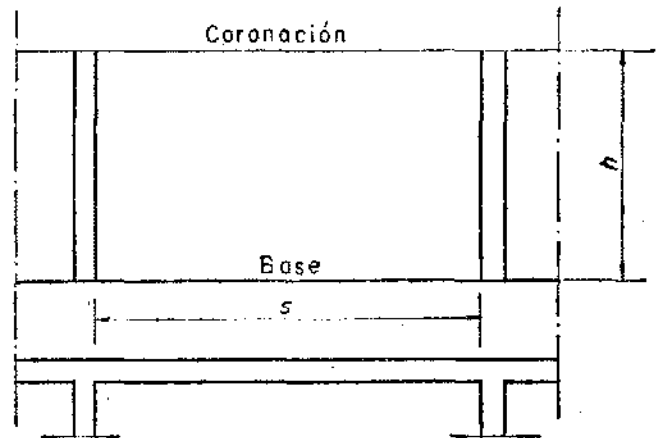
Elemento de muro con arriostramientos transversales
